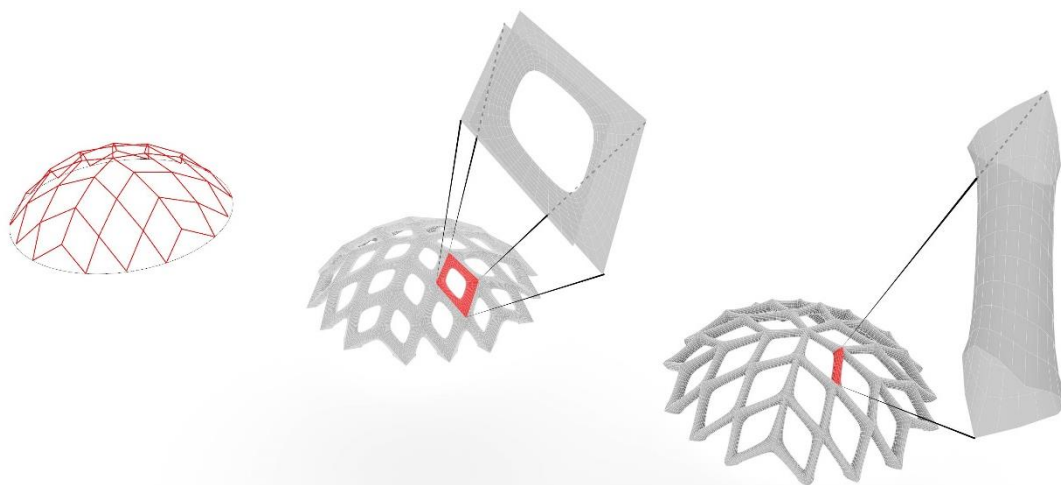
Globale Segmentierung und Entwicklung der Bauteilgeometrien
